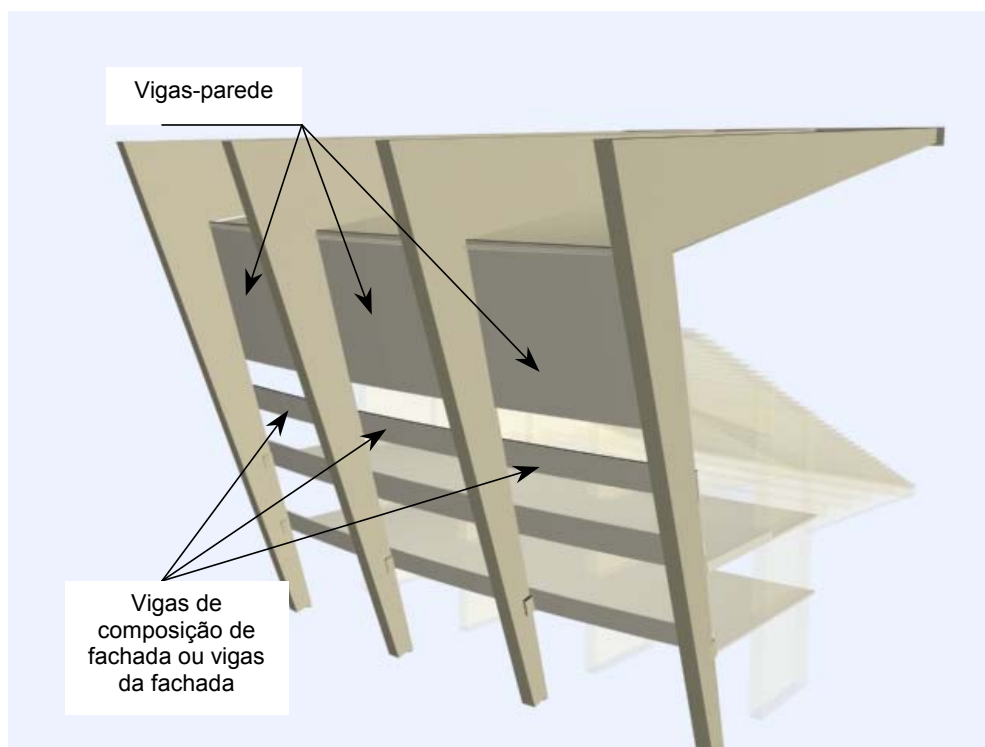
Croquis da fachada externa do Mineirão
